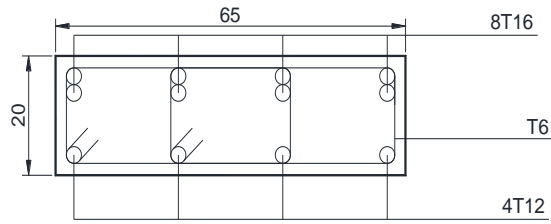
Coupe longitudinale d'une poutre noyée principale 65x20cm (plancher au dalles pleines)
